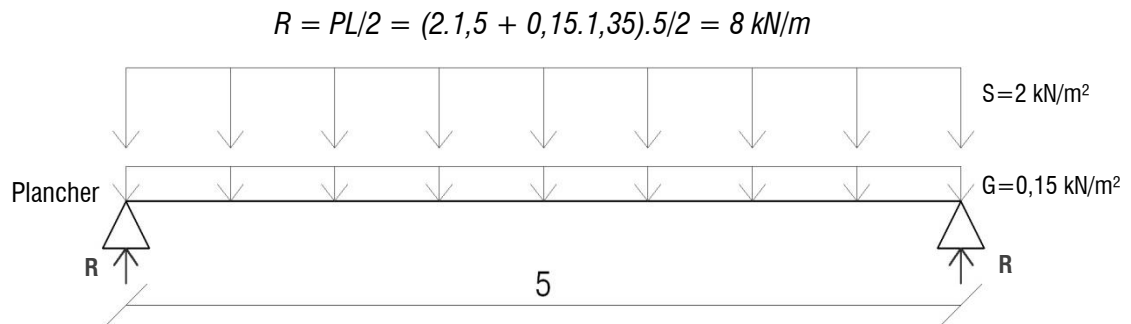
Réaction de la poutre aux charges du plancher (coupe)
